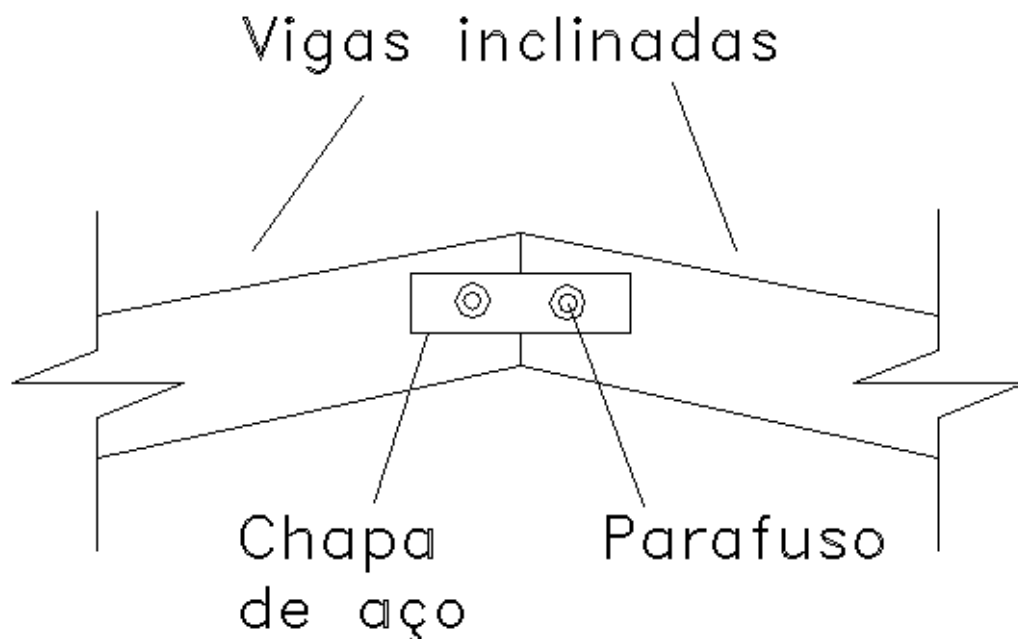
Ligação viga-viga por chapas e parafusos.
